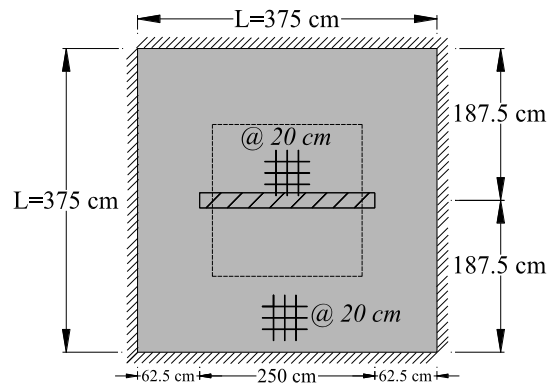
Vista en planta de la losa maciza con un muro apoyado sobre ella
